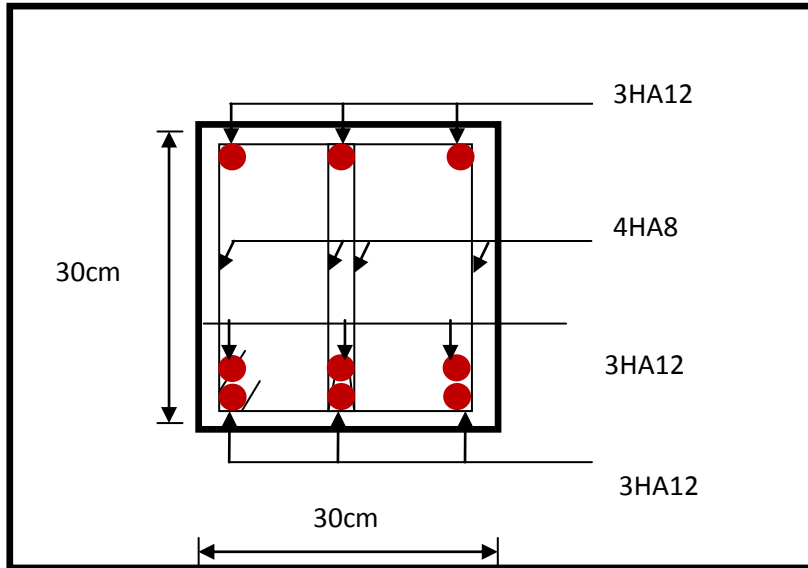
Ferrailage en travée d’une poutre secondaire.
